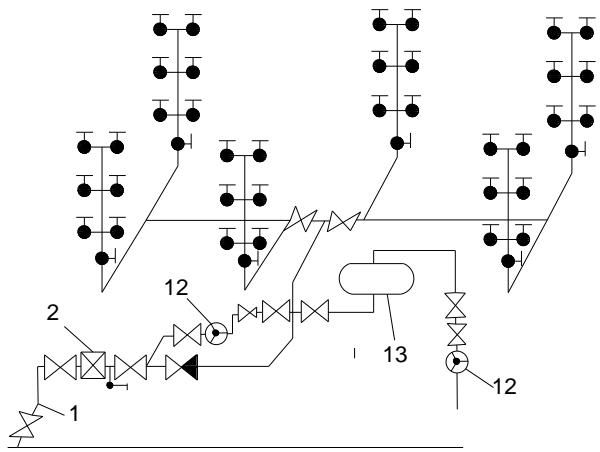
Система без дополнительных устройств, для повышения напора с гидропневматическими установками:
